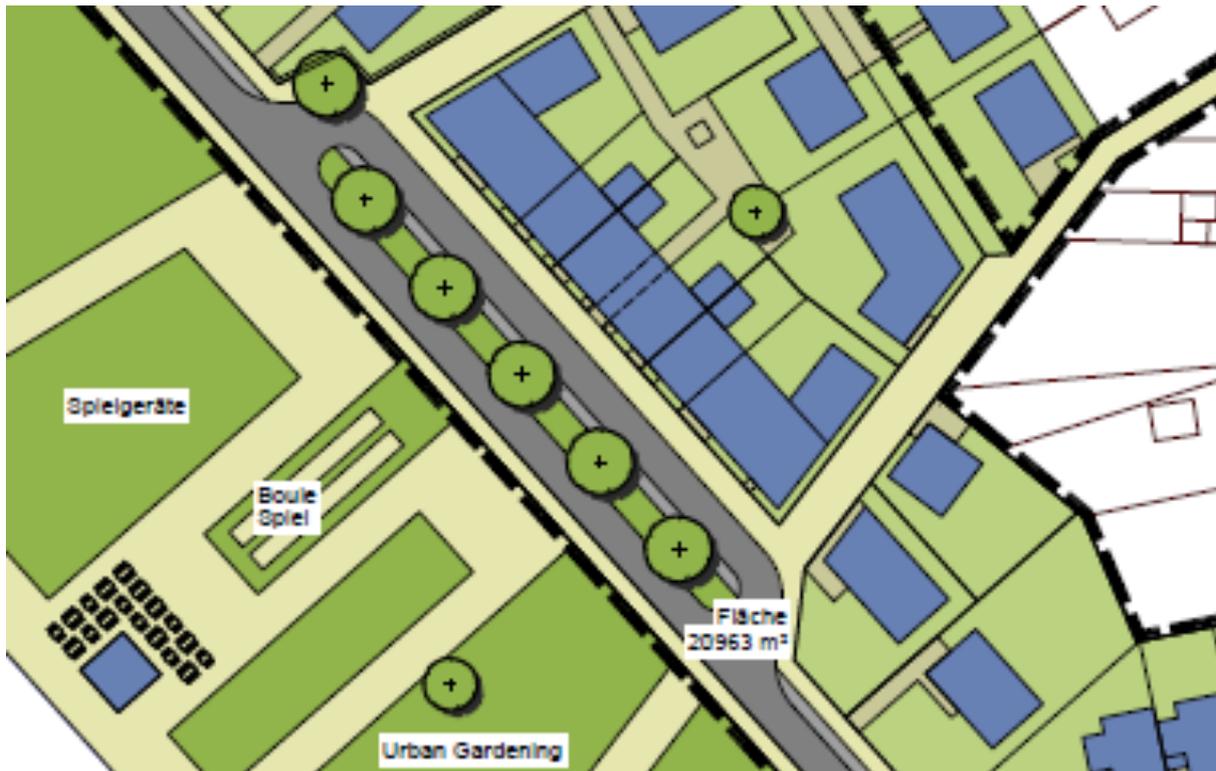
Ausschnitt Planungsstand 06/2022 von Bild 8: Planverfahren "Bartholomäus Pfädchen", Inden Schophoven, Gemeinde Inden, HJP Planer
